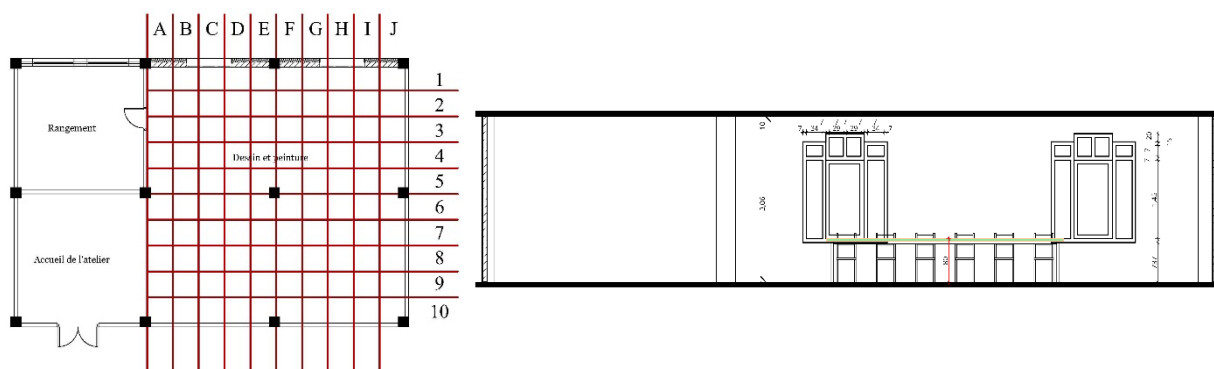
Plan et coupe de l'atelier avec une grille de 1*1 m (Source : Auteur, 2025)
